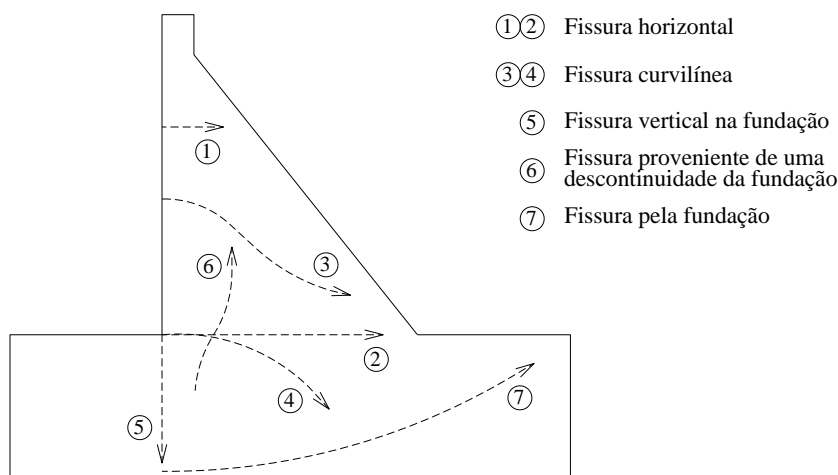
Localização de fissuras em barragens gravidade (adaptado de Léger, 2005)
